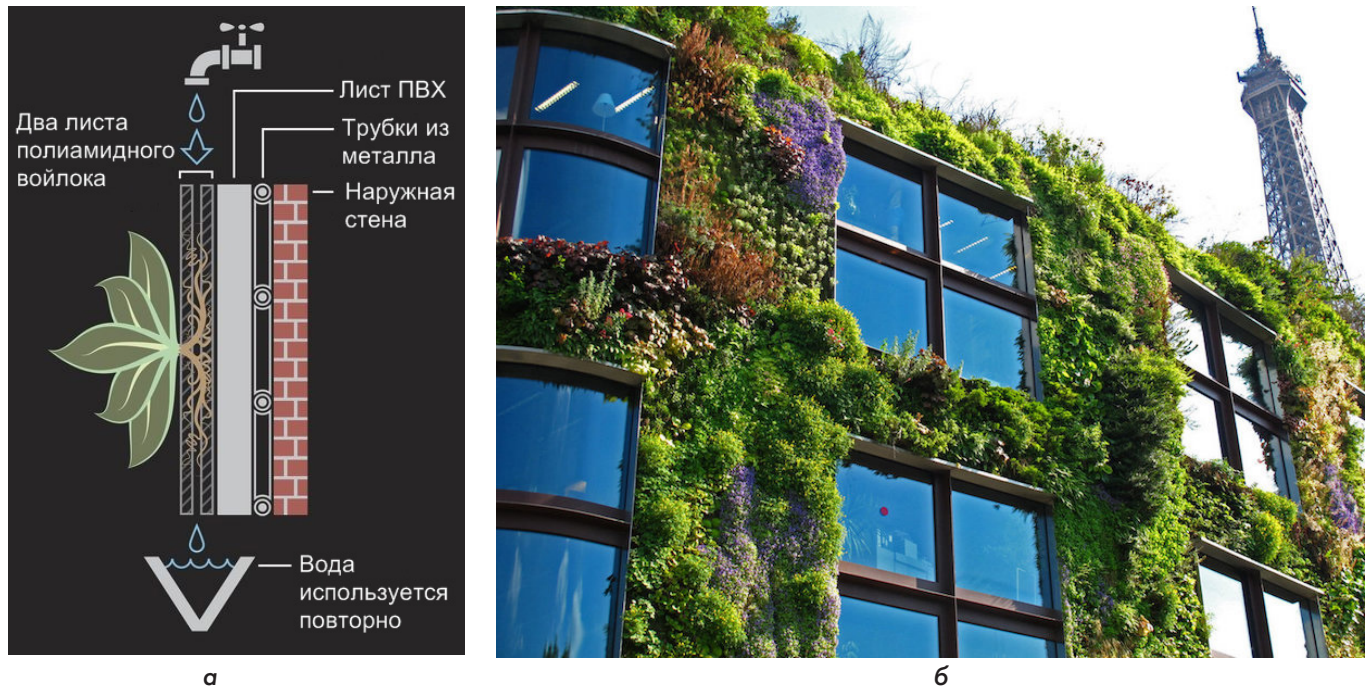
«Живая стена» Патрика Блана: а – основные элементы конструкции¹¹; б – фрагмент фасада административного здания Музея на набережной Бранли (Париж, Франция, 2006 год)¹²
